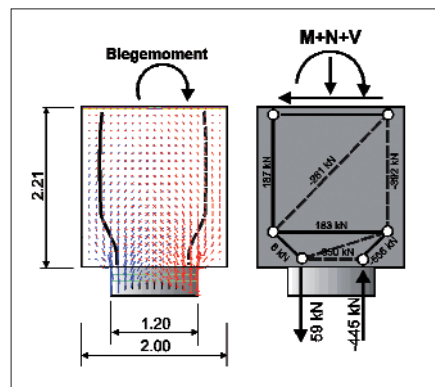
Stabwerkmodell des Pfahlkopfbalkens
